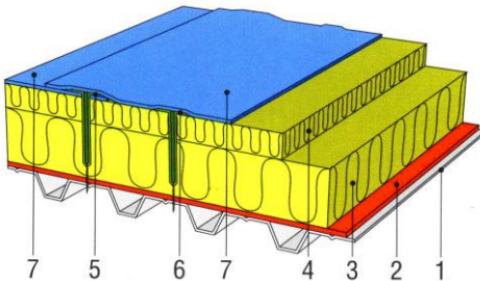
Двухслойное теплоизоляционное решение кровли с однослойным покрытием из полимерных мембран и механическим креплением: 1 — несущий стальной профилированный настил; 2 — пароизоляционный слой; 3 — теплоизоляционный слой из плит РУФ БАТТС Н; 4 — теплоизоляционный слой из плит РУФ БАТТС В; 5 — механическое крепление (фиксация гидроизоляционной мембранны); 6 — механическое крепление (фиксация теплоизоляции к основанию); 7 — слой насухо уложенного гидроизоляционного ковра из полимерных мембран ПВХ
